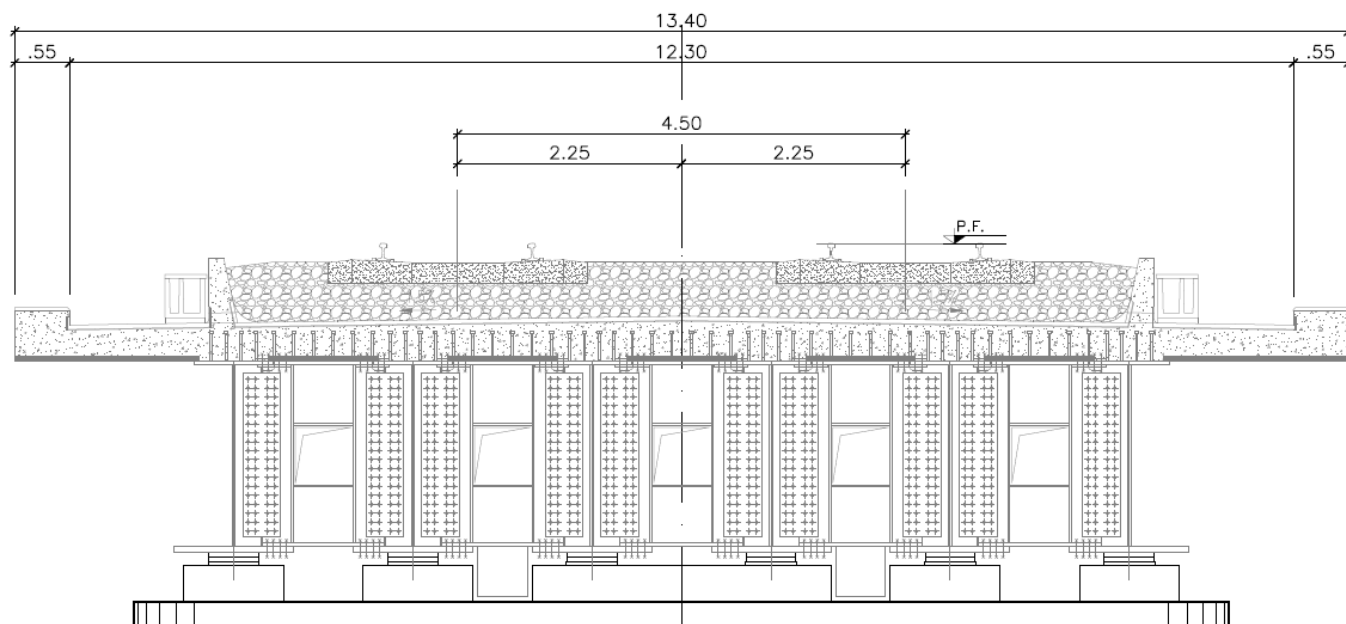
Sezione trasversale tipo dell'impalcato da 40 m (6 travi).
